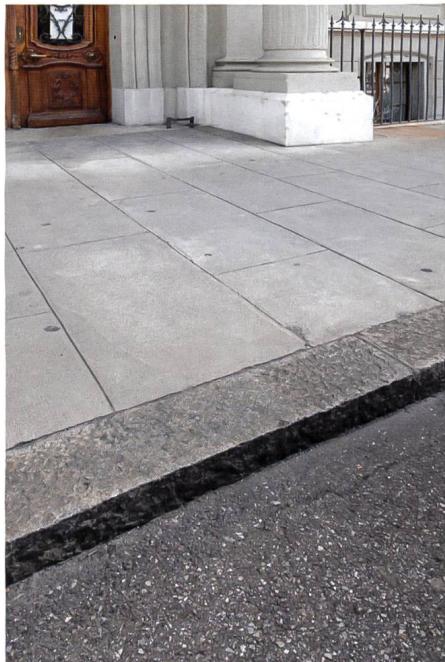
Un trottoir genevois caractéristique : ciment imitant les dalles de pierre
